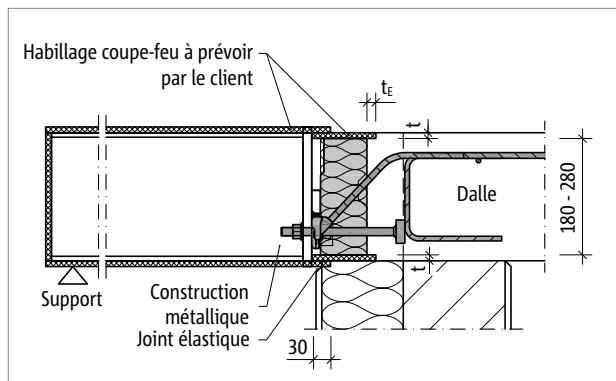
Schöck Isokorb® type SQ : bardage de protection incendie sur site type SQ et structure en acier ; coupe
